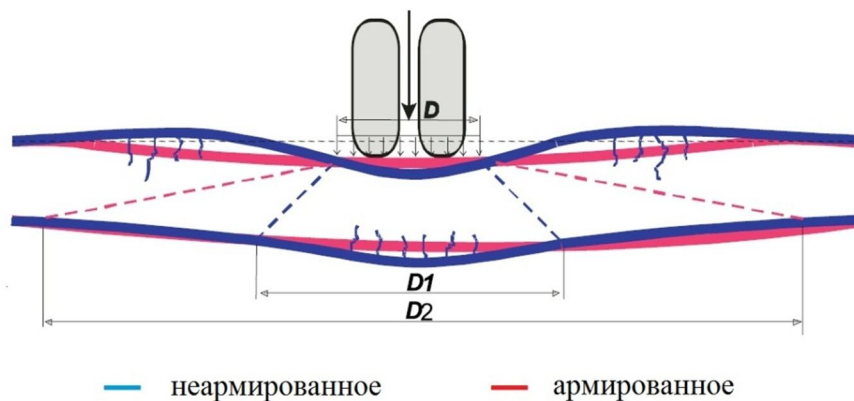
Асфальтобетонное покрытие под колесной нагрузкой
